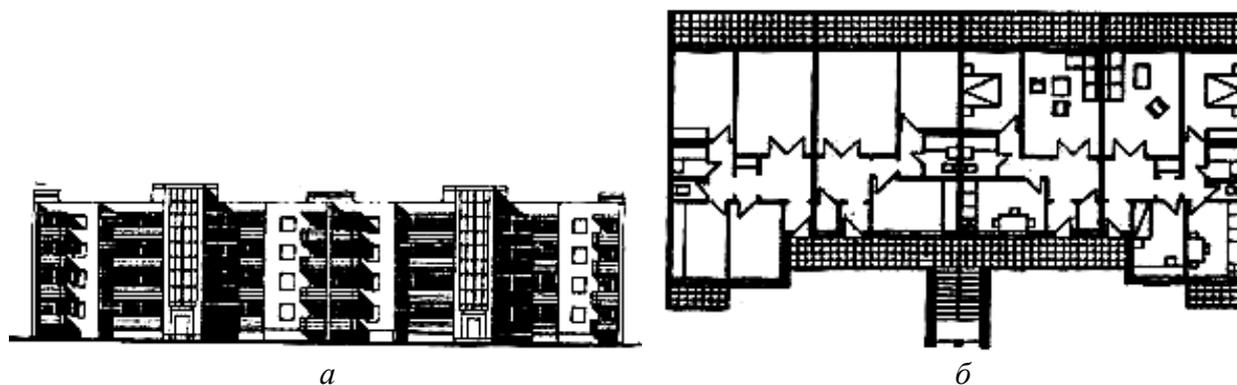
Галерейно-секционный жилой дом: *а* — фасад; *б* — план типового этажа
